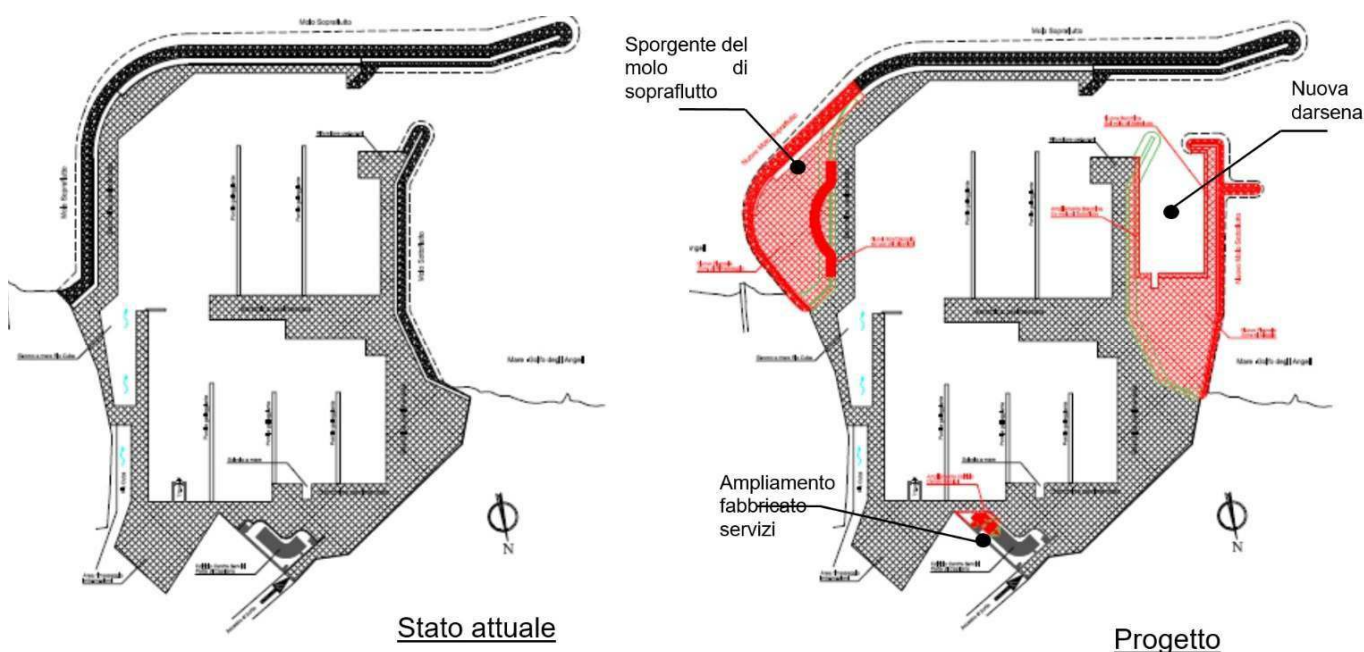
Confronto dell'assetto planimetrico del porto (stato attuale e progetto)
